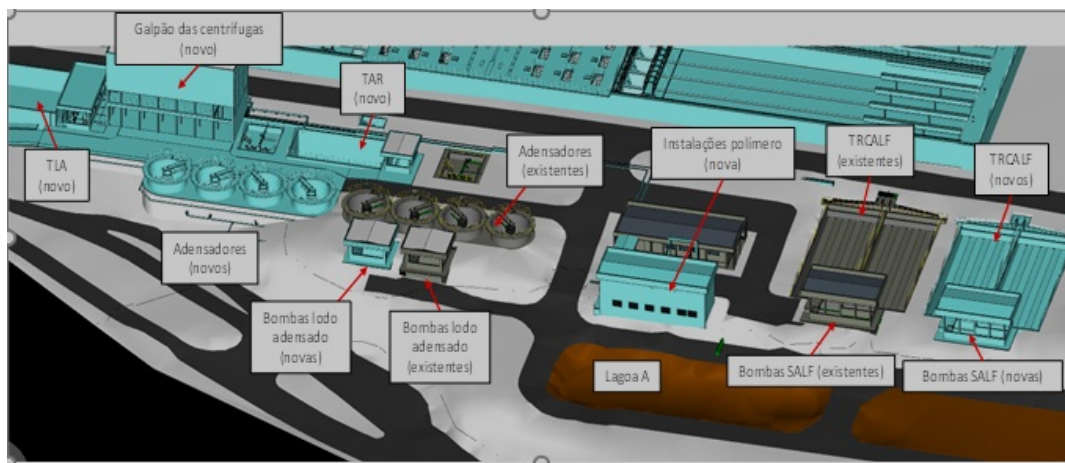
Detalhe da planta da UTR - Fonte: Arcadis.
